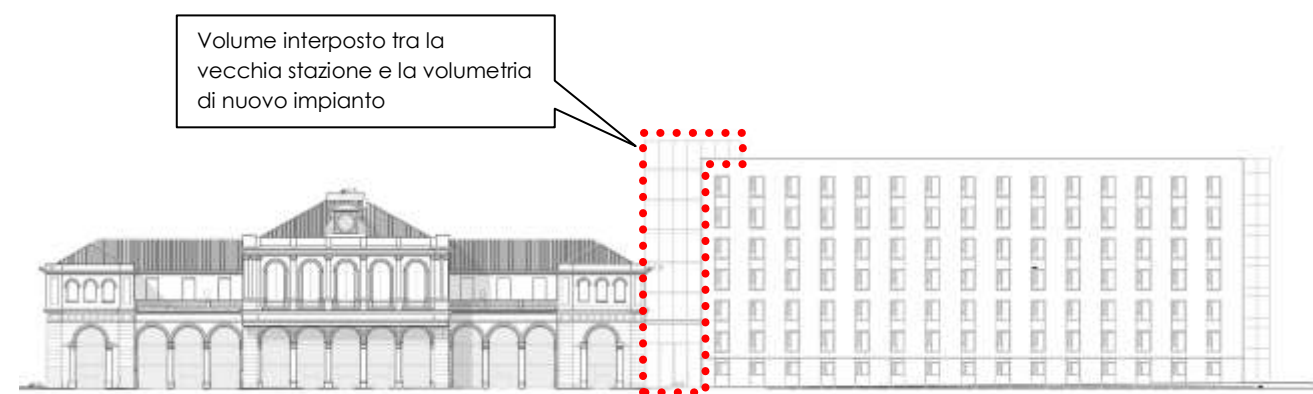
Prospetto verso Piazza XVIII dicembre: rapporto fra edificio storico e nuova volumetria
